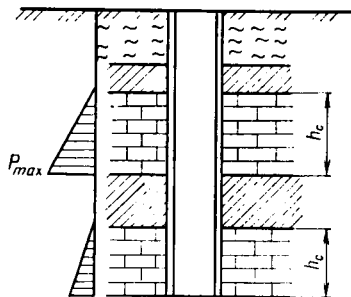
Схема к расчету нагрузки на крепь вертикальной выработки методом Ю. А. Онищенко
